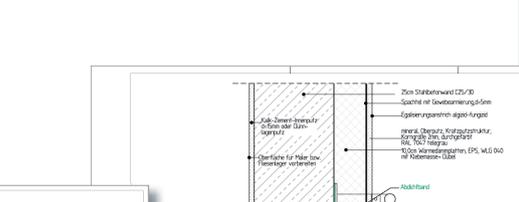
Sockel im Bereich hinterlieferte Fassade mit Giebelwand
